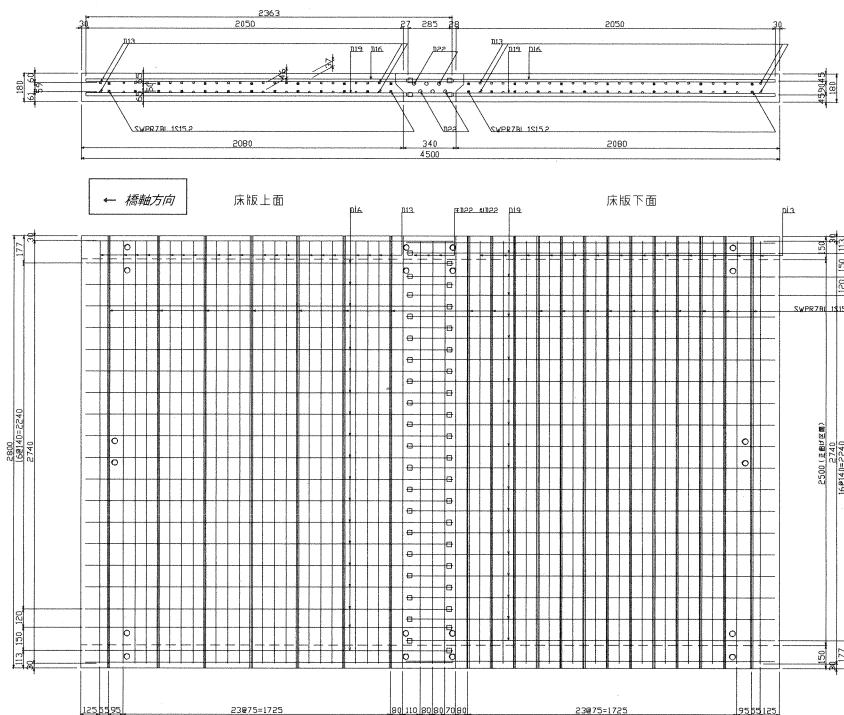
供試体の形状寸法、PC鋼材および鉄筋配置図
